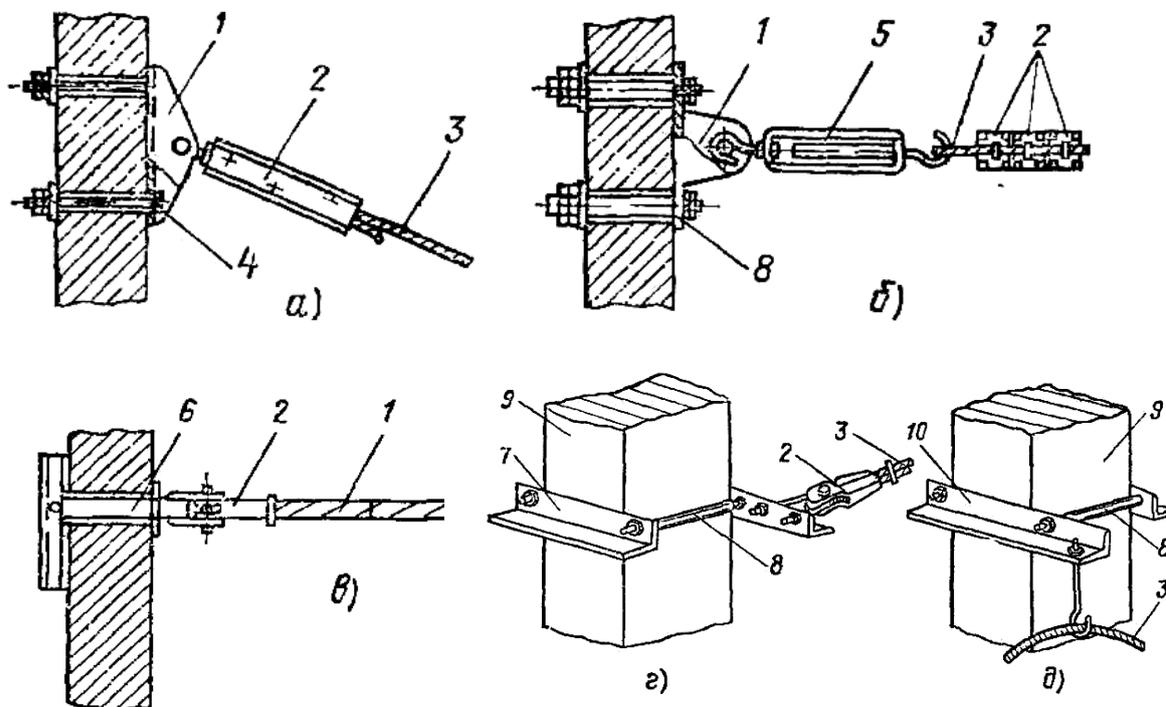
Установка анкеров на стене и обхватов на колонне:
